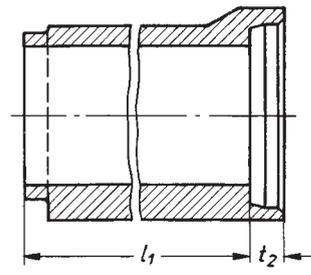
Betonrohr mit Kreisquerschnitt mit Fuß, wandverstärkt (KFW), mit Muffe (M)
